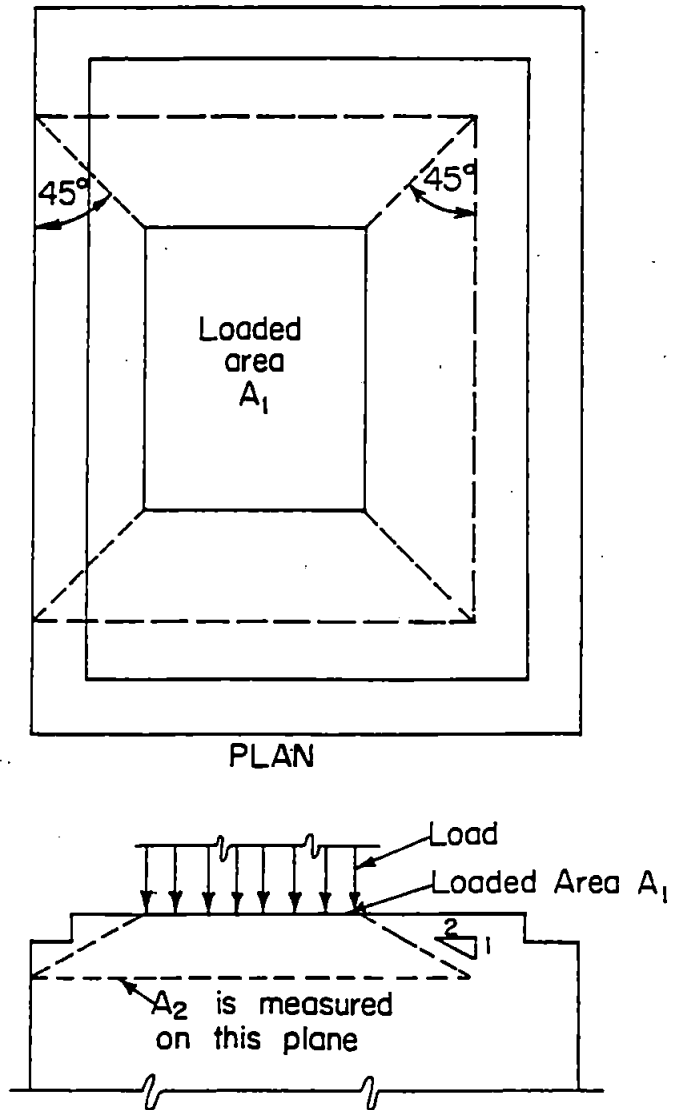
Aplicación de la pirámide para determinar  $A_2$  en apoyos escalonados o inclinados.
